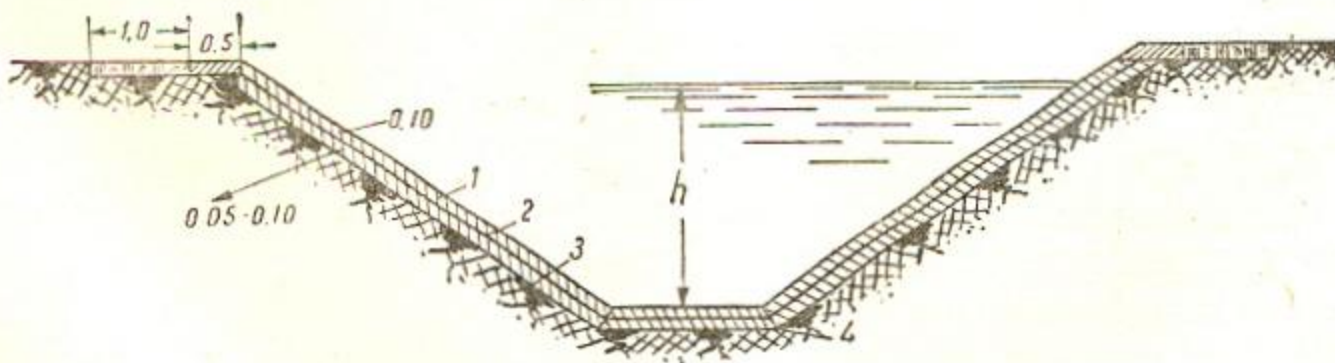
Двухслойная бетонная или армобетонная одежда с гидроизоляцией:
